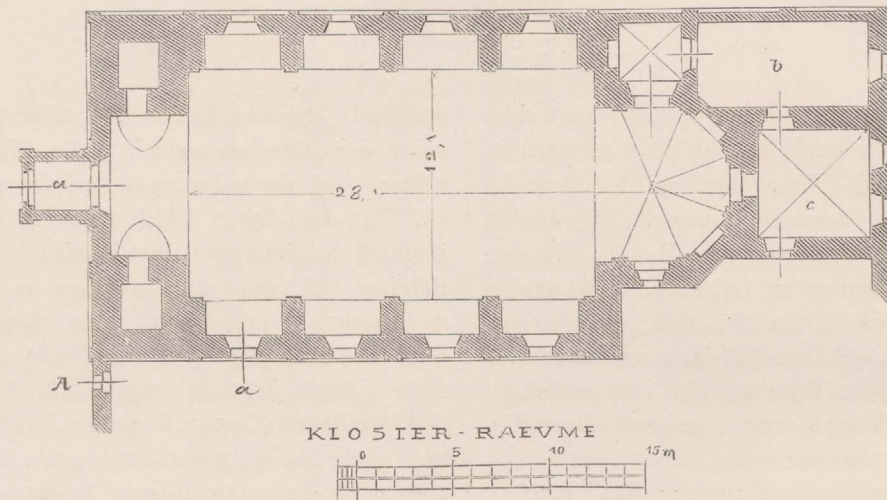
Rehwalde. Grundriss der ehemaligen Klosterkirche.
